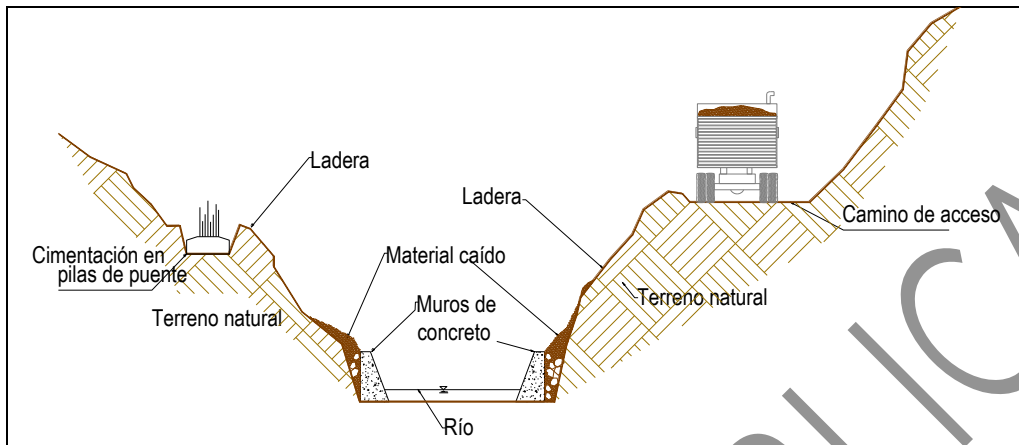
Esquema tipo de la colocación de una barrera de concreto en los márgenes de un río.
